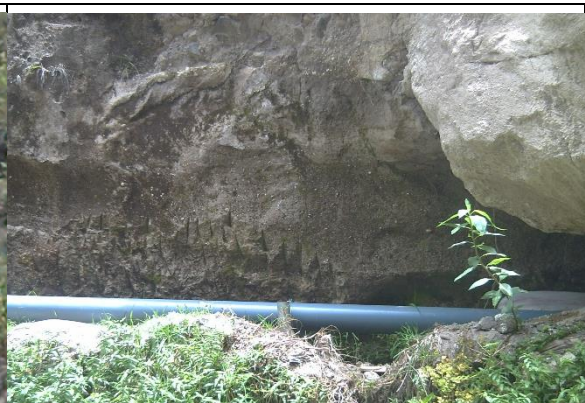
Conducción de tubo PVC de 160 mm de diámetro.
